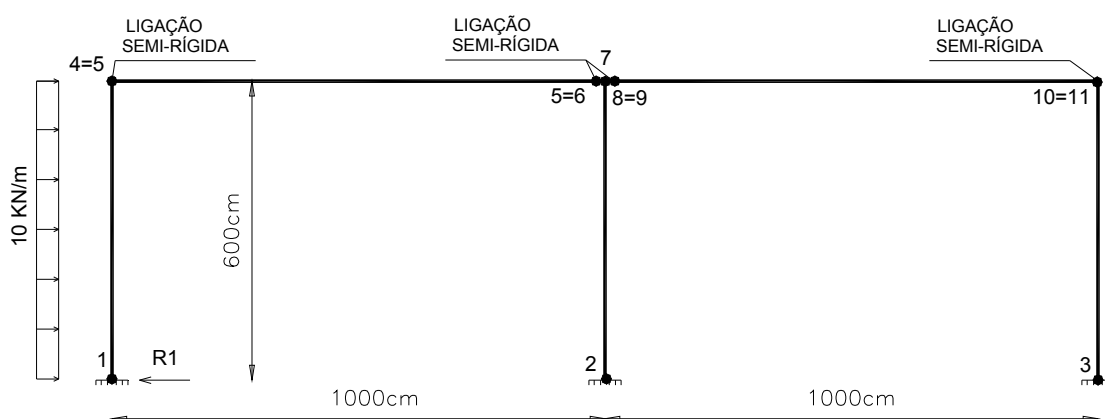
Pórtico plano para análise com ligação semi-rígida.
